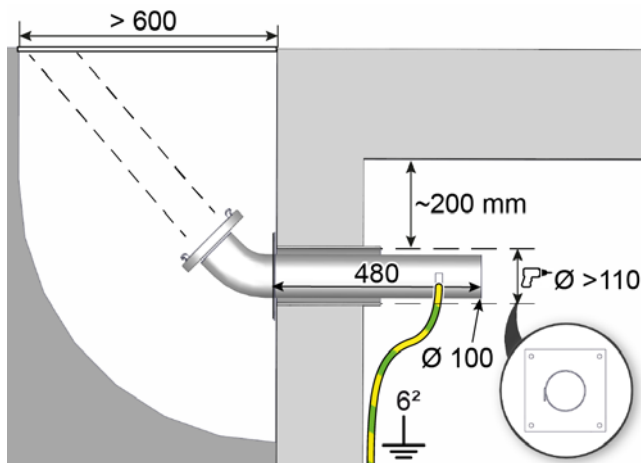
Dimensions pour tubes de remplissage coudés
